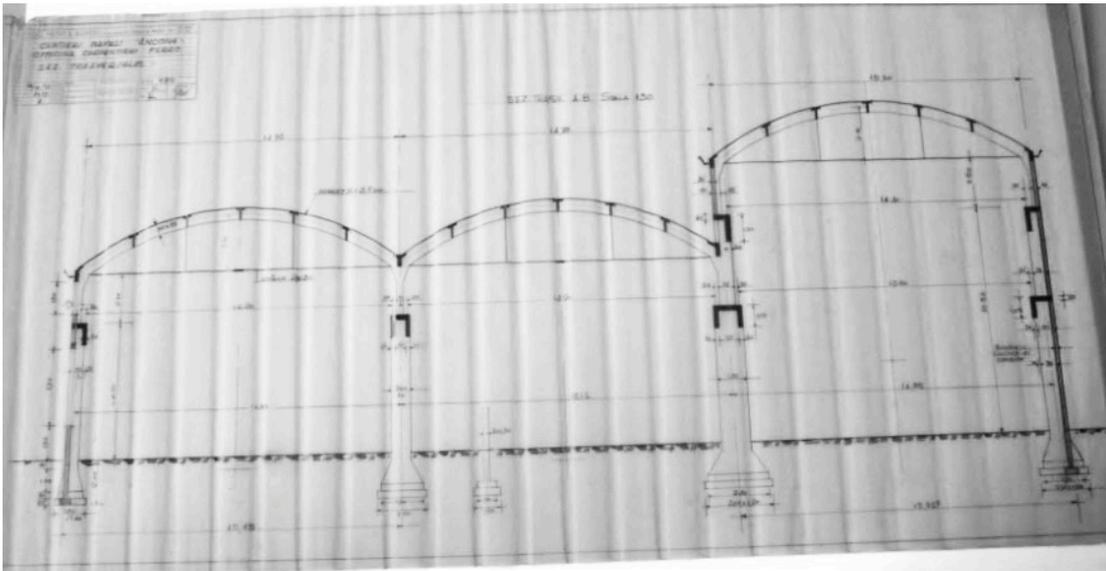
Sezione trasversale, Officina Carpentieri Ancona, CSAC Fondo Nervi
